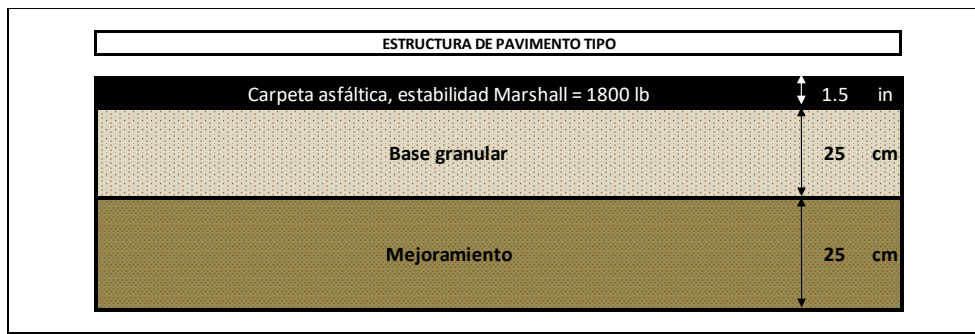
Estructura tipo de pavimento utilizado para el cálculo del método convencional de tendido por capas.
